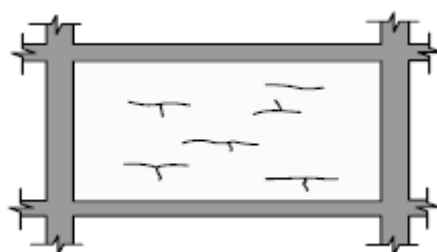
Trincas horizontais na alvenaria provenientes da expansão dos tijolos. (Fonte: THOMAZ)
